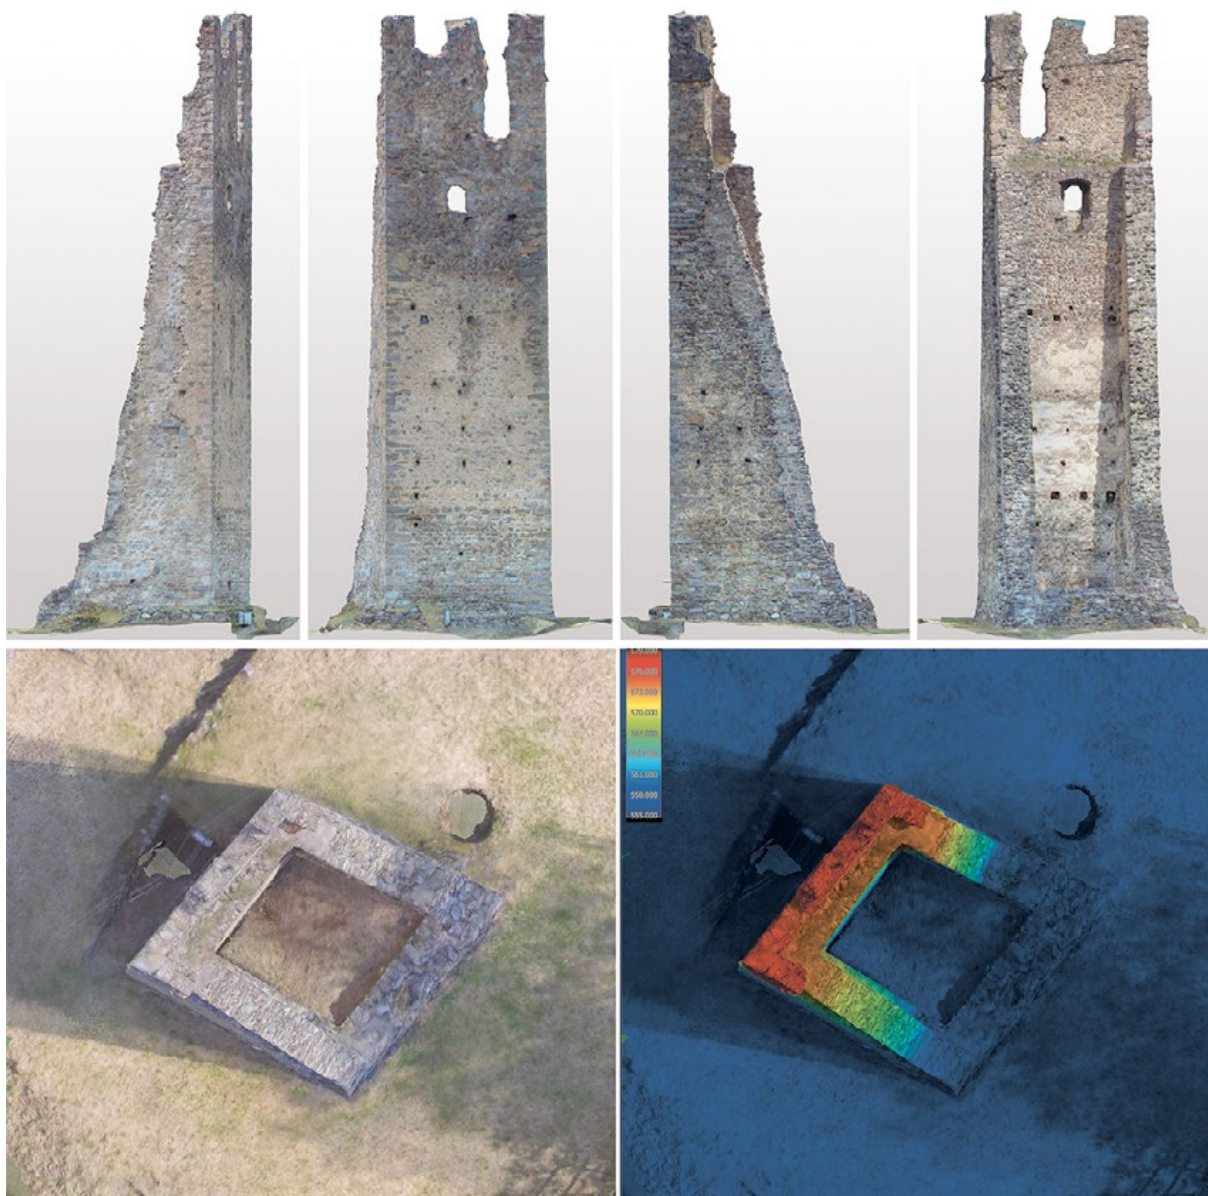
La restituzione della planimetria e degli alzati ottenuti dal modello 3D fotogrammetrico.
